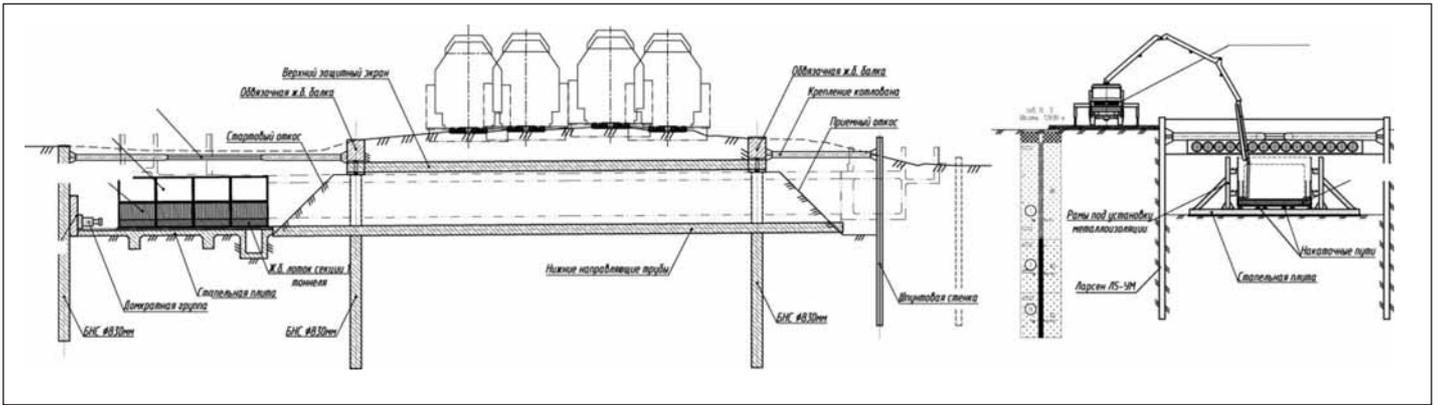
Бетонирование на стапеле нижней плиты железобетонной секции
